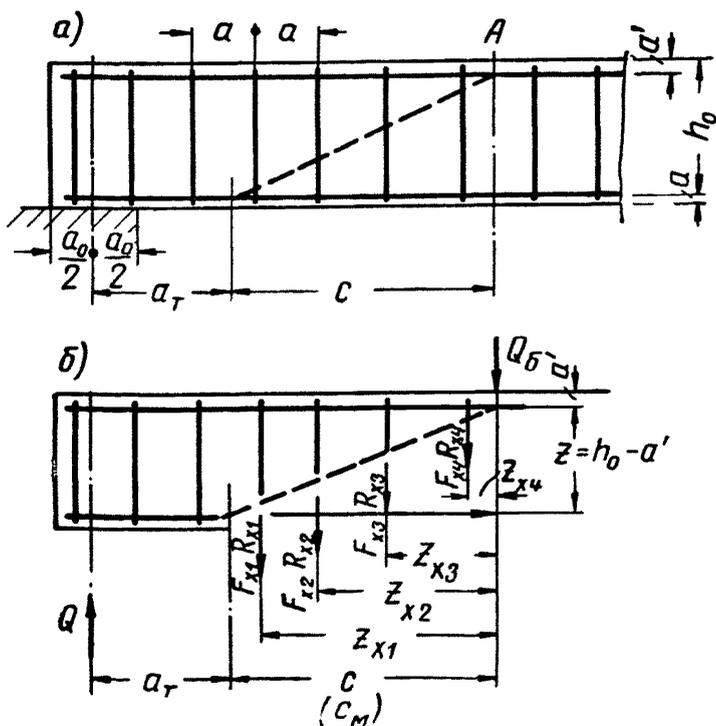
К расчету изгибаемых элементов по косым сечениям
